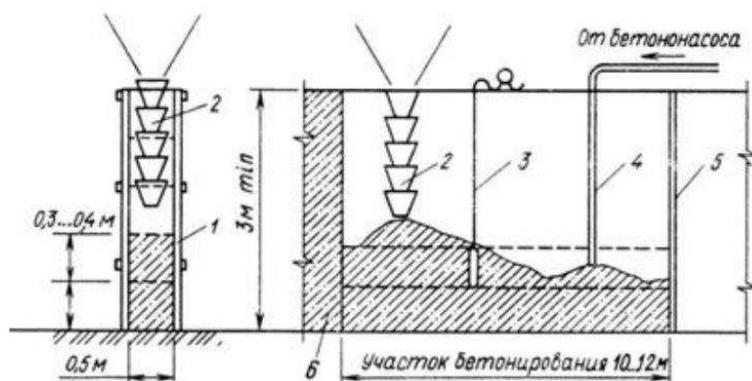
Укладка бетонной смеси в стены с подачей бетонной смеси бадьями: 1 - опалубка; 2 - звеньевой хобот с воронкой; 3 - вибратор с гибким валом; 4 - шланг бетононасоса; 5 - разделительная опалубка; 6 - ранее забетонированный участок стены.
